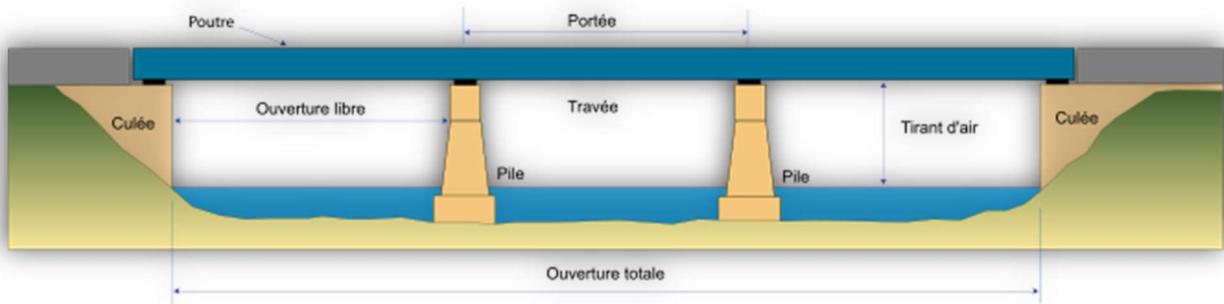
Schéma des principaux éléments constructifs d'un pont
